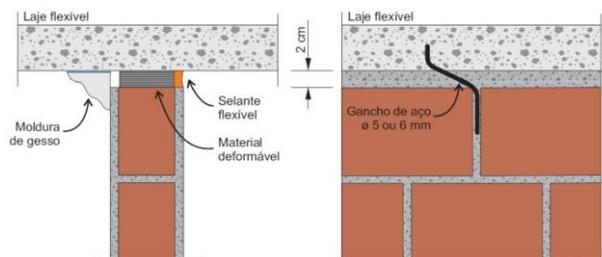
Encontro de alvenaria com laje ou viga deformável
